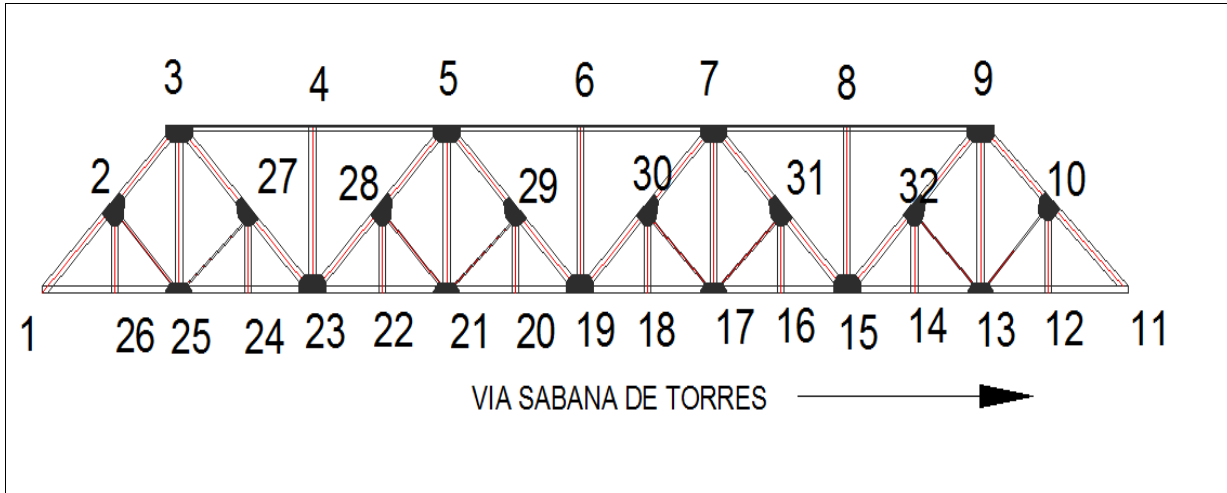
Denominación de los nodos en la armadura, Puente2. Fuente (Autores).
